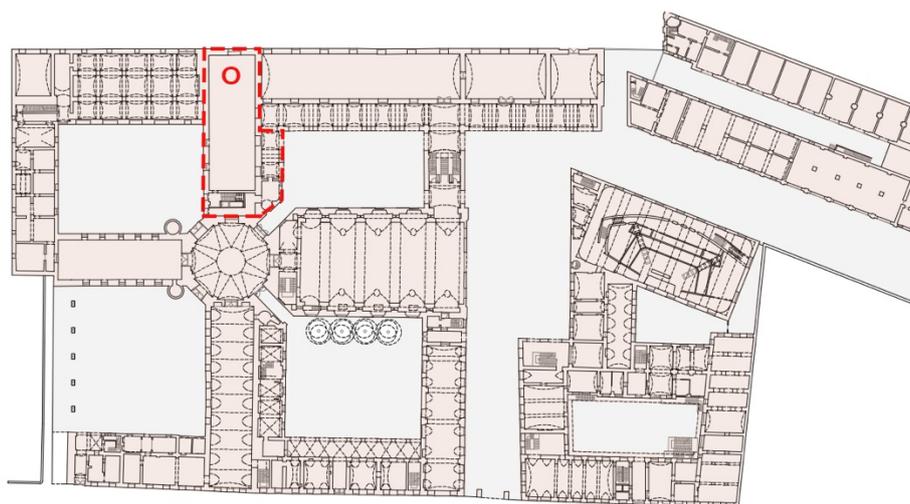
planimetria con evidenza edificio O - elaborazione personale
